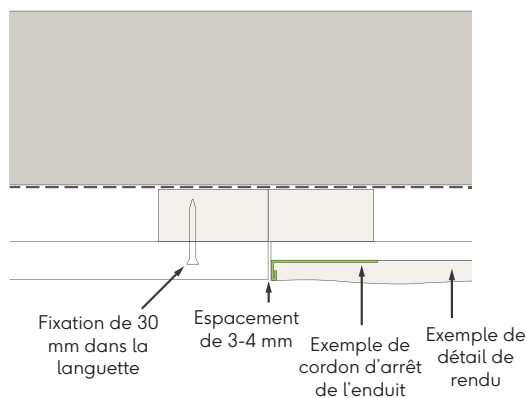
Assemblage bout à bout jusqu'à l'enduit
